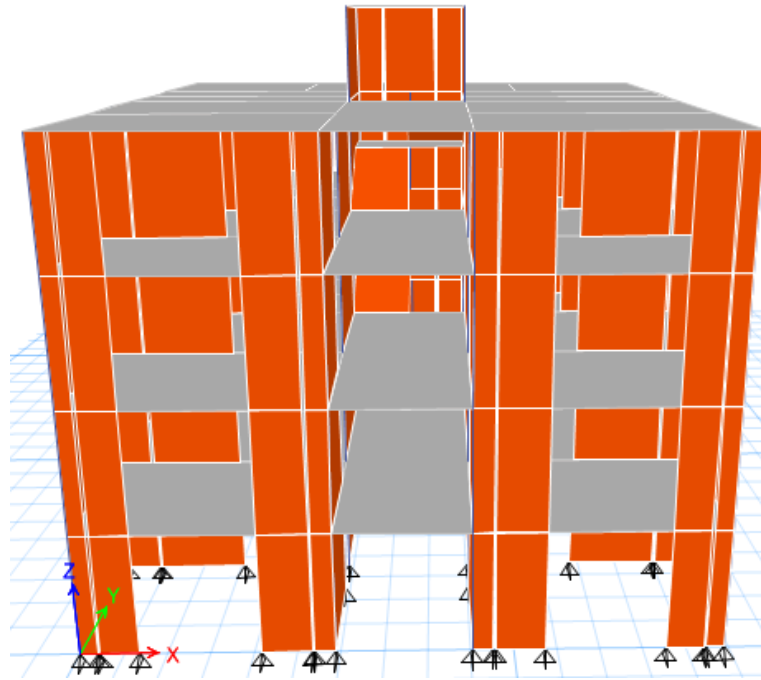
Vista elevación de fachada Eje “X” (Fuente: Elaboración propia)
